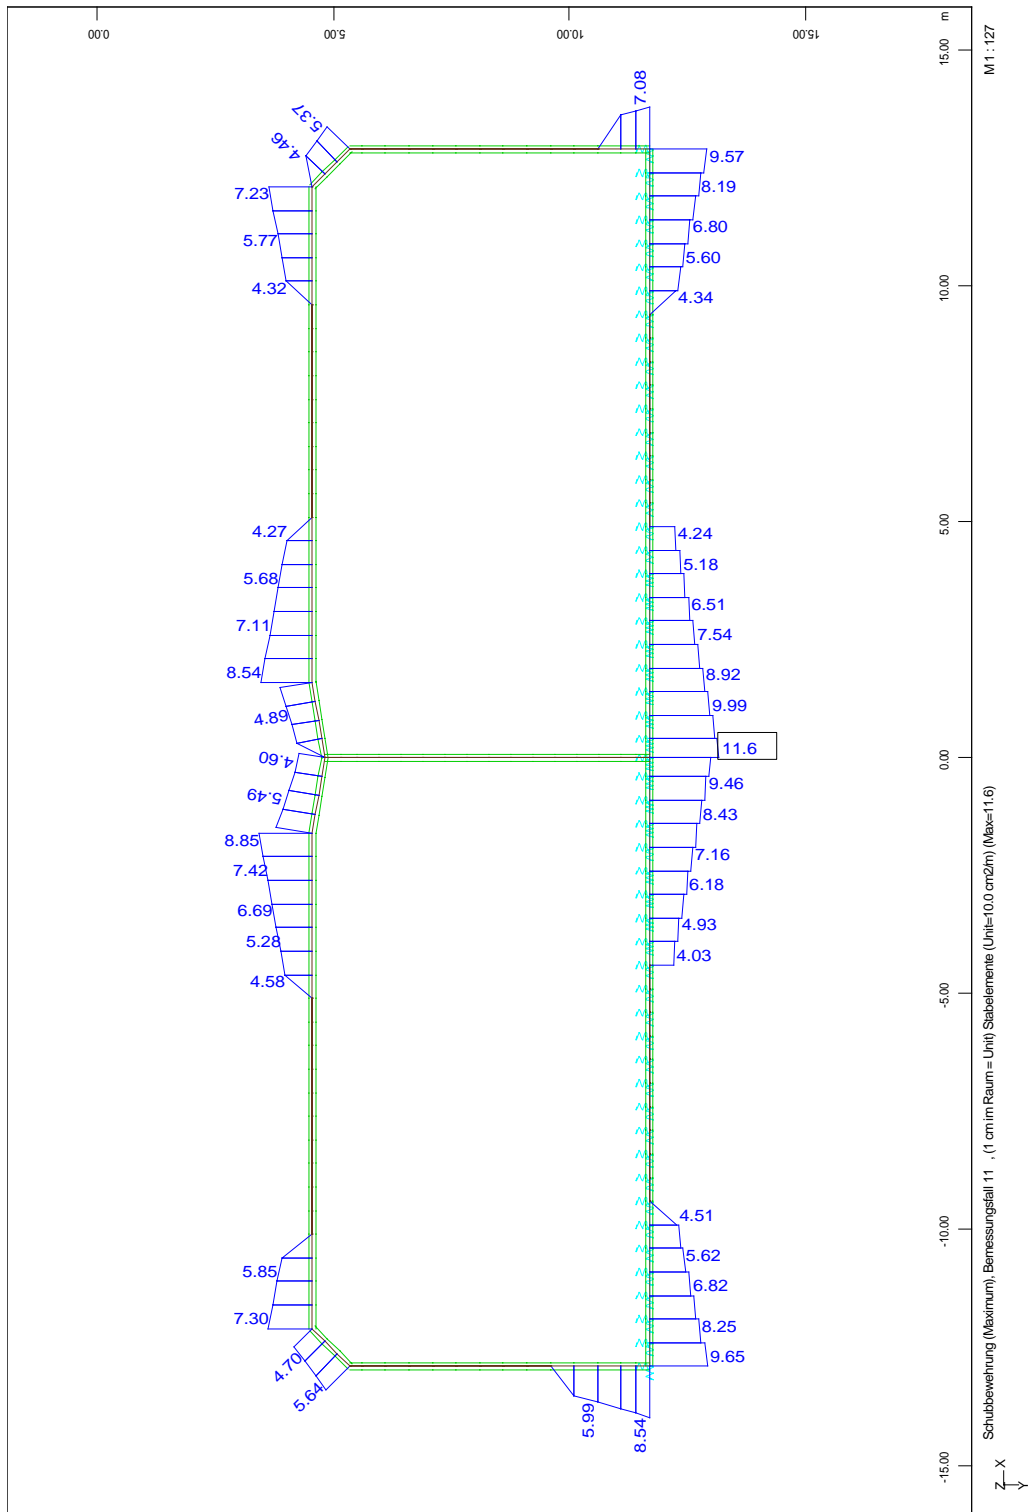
Schubbewehrung, außergewöhnliche Bemessungssituation
